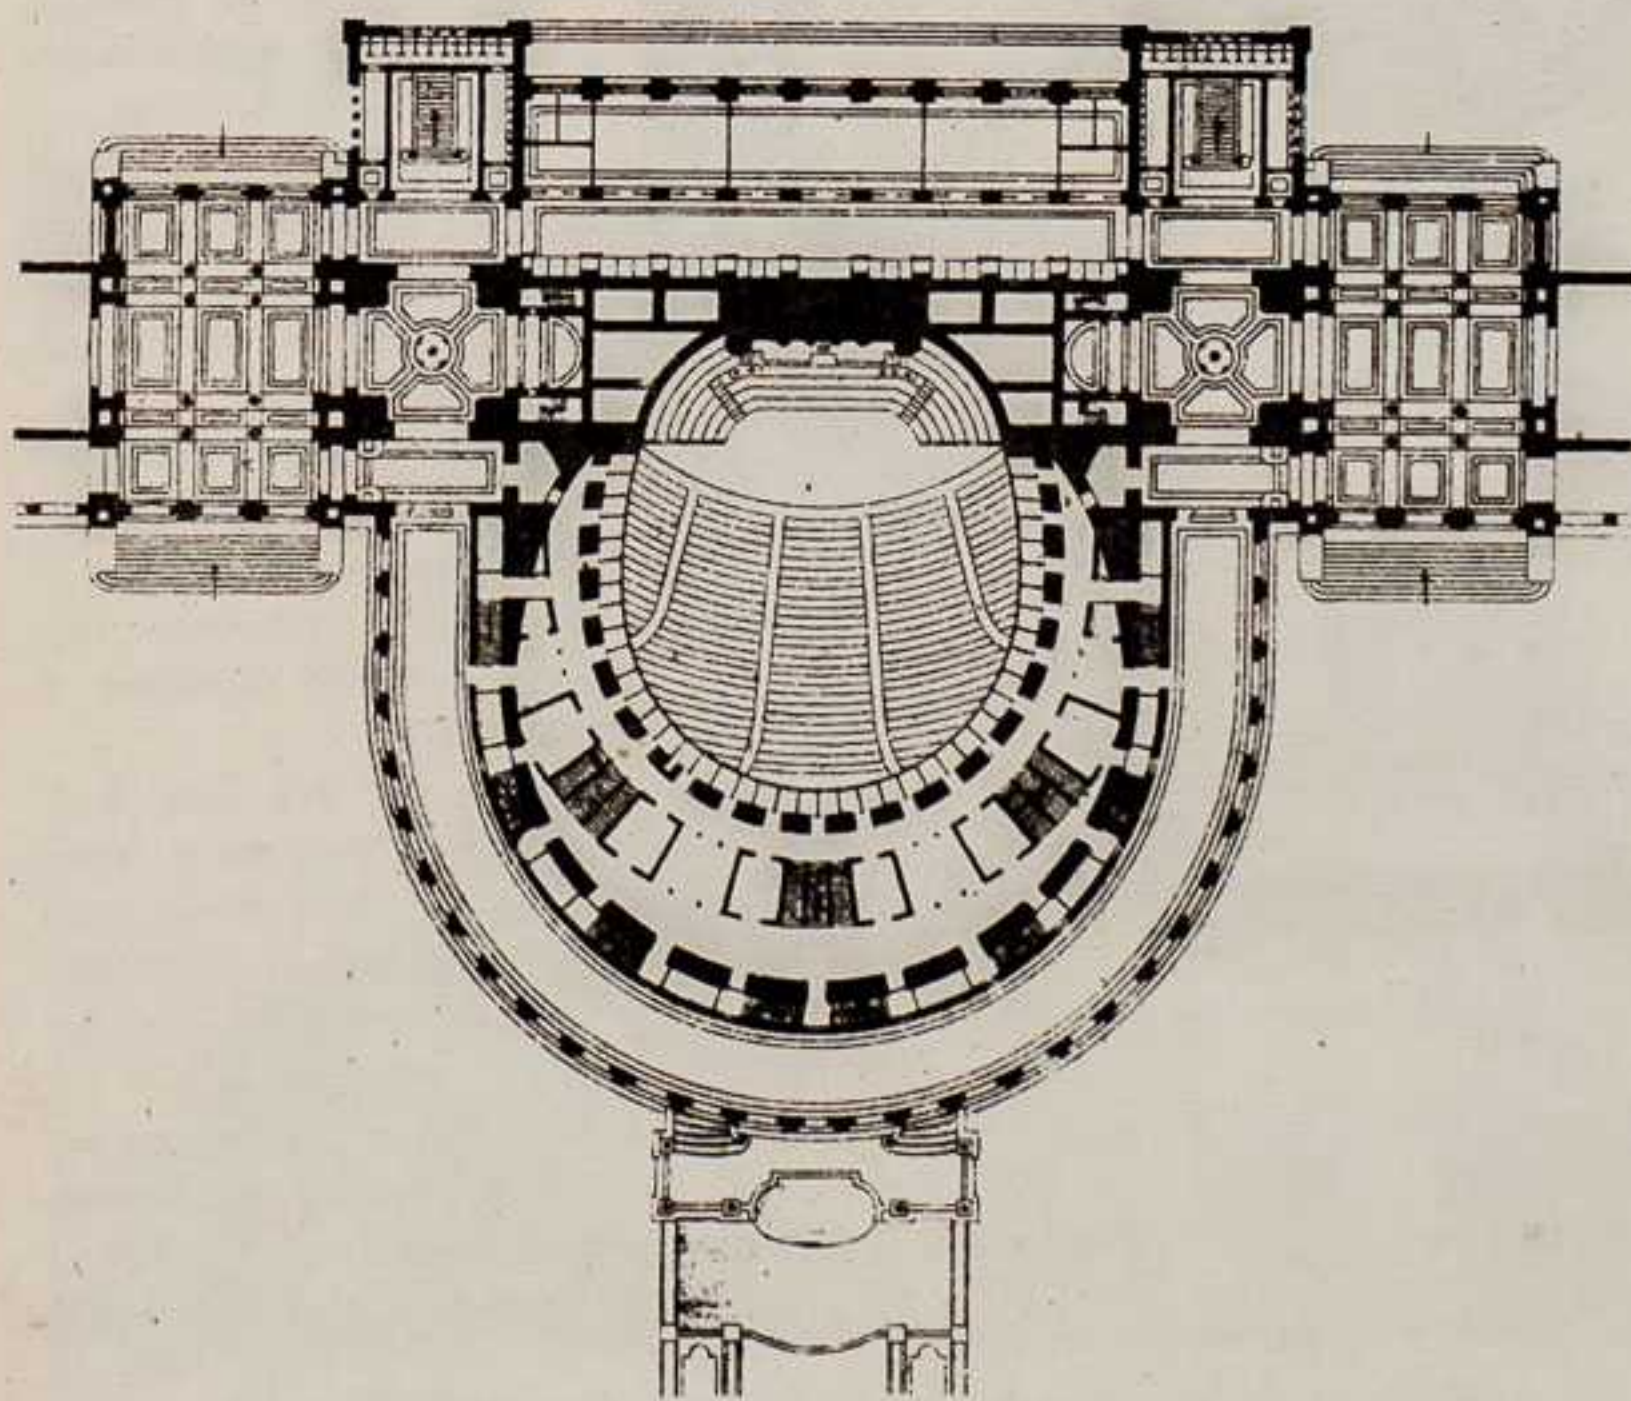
Il Trocadero. Sezione orizzontale (piano inferiore). Scala di 0<sup>m</sup> 001 p. metro. (Veggasi pure la pianta generale del Trocadero nella Tav. I).
